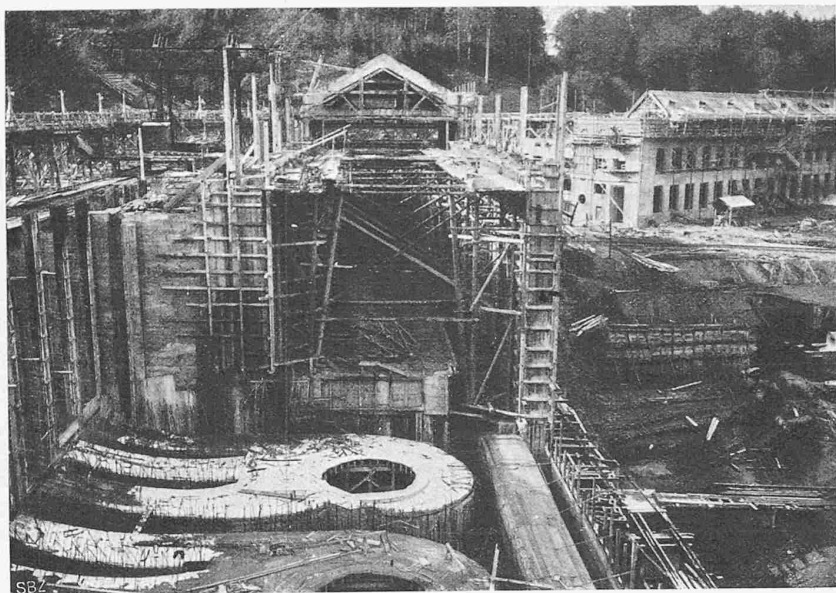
Maschinenhaus im Bau, Ansicht gegen Westen.
